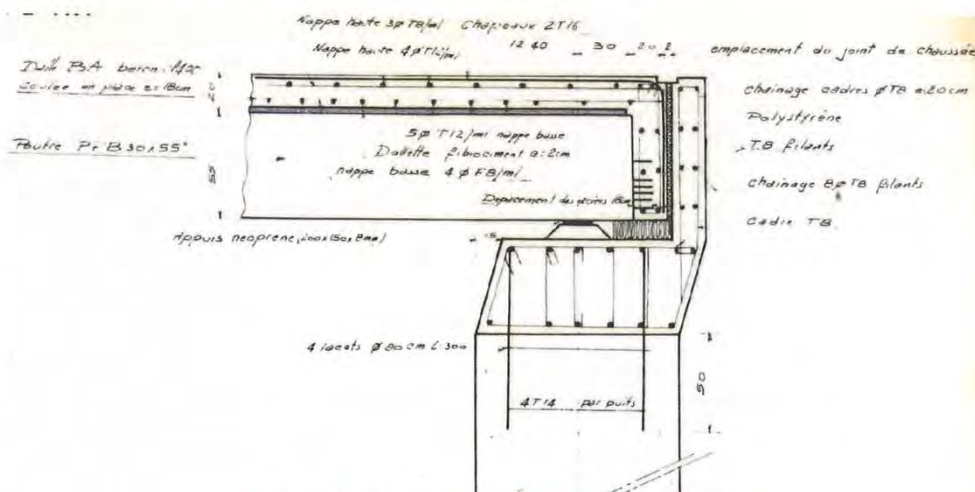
Coupe sur culée (Extrait des plans d'archives)
